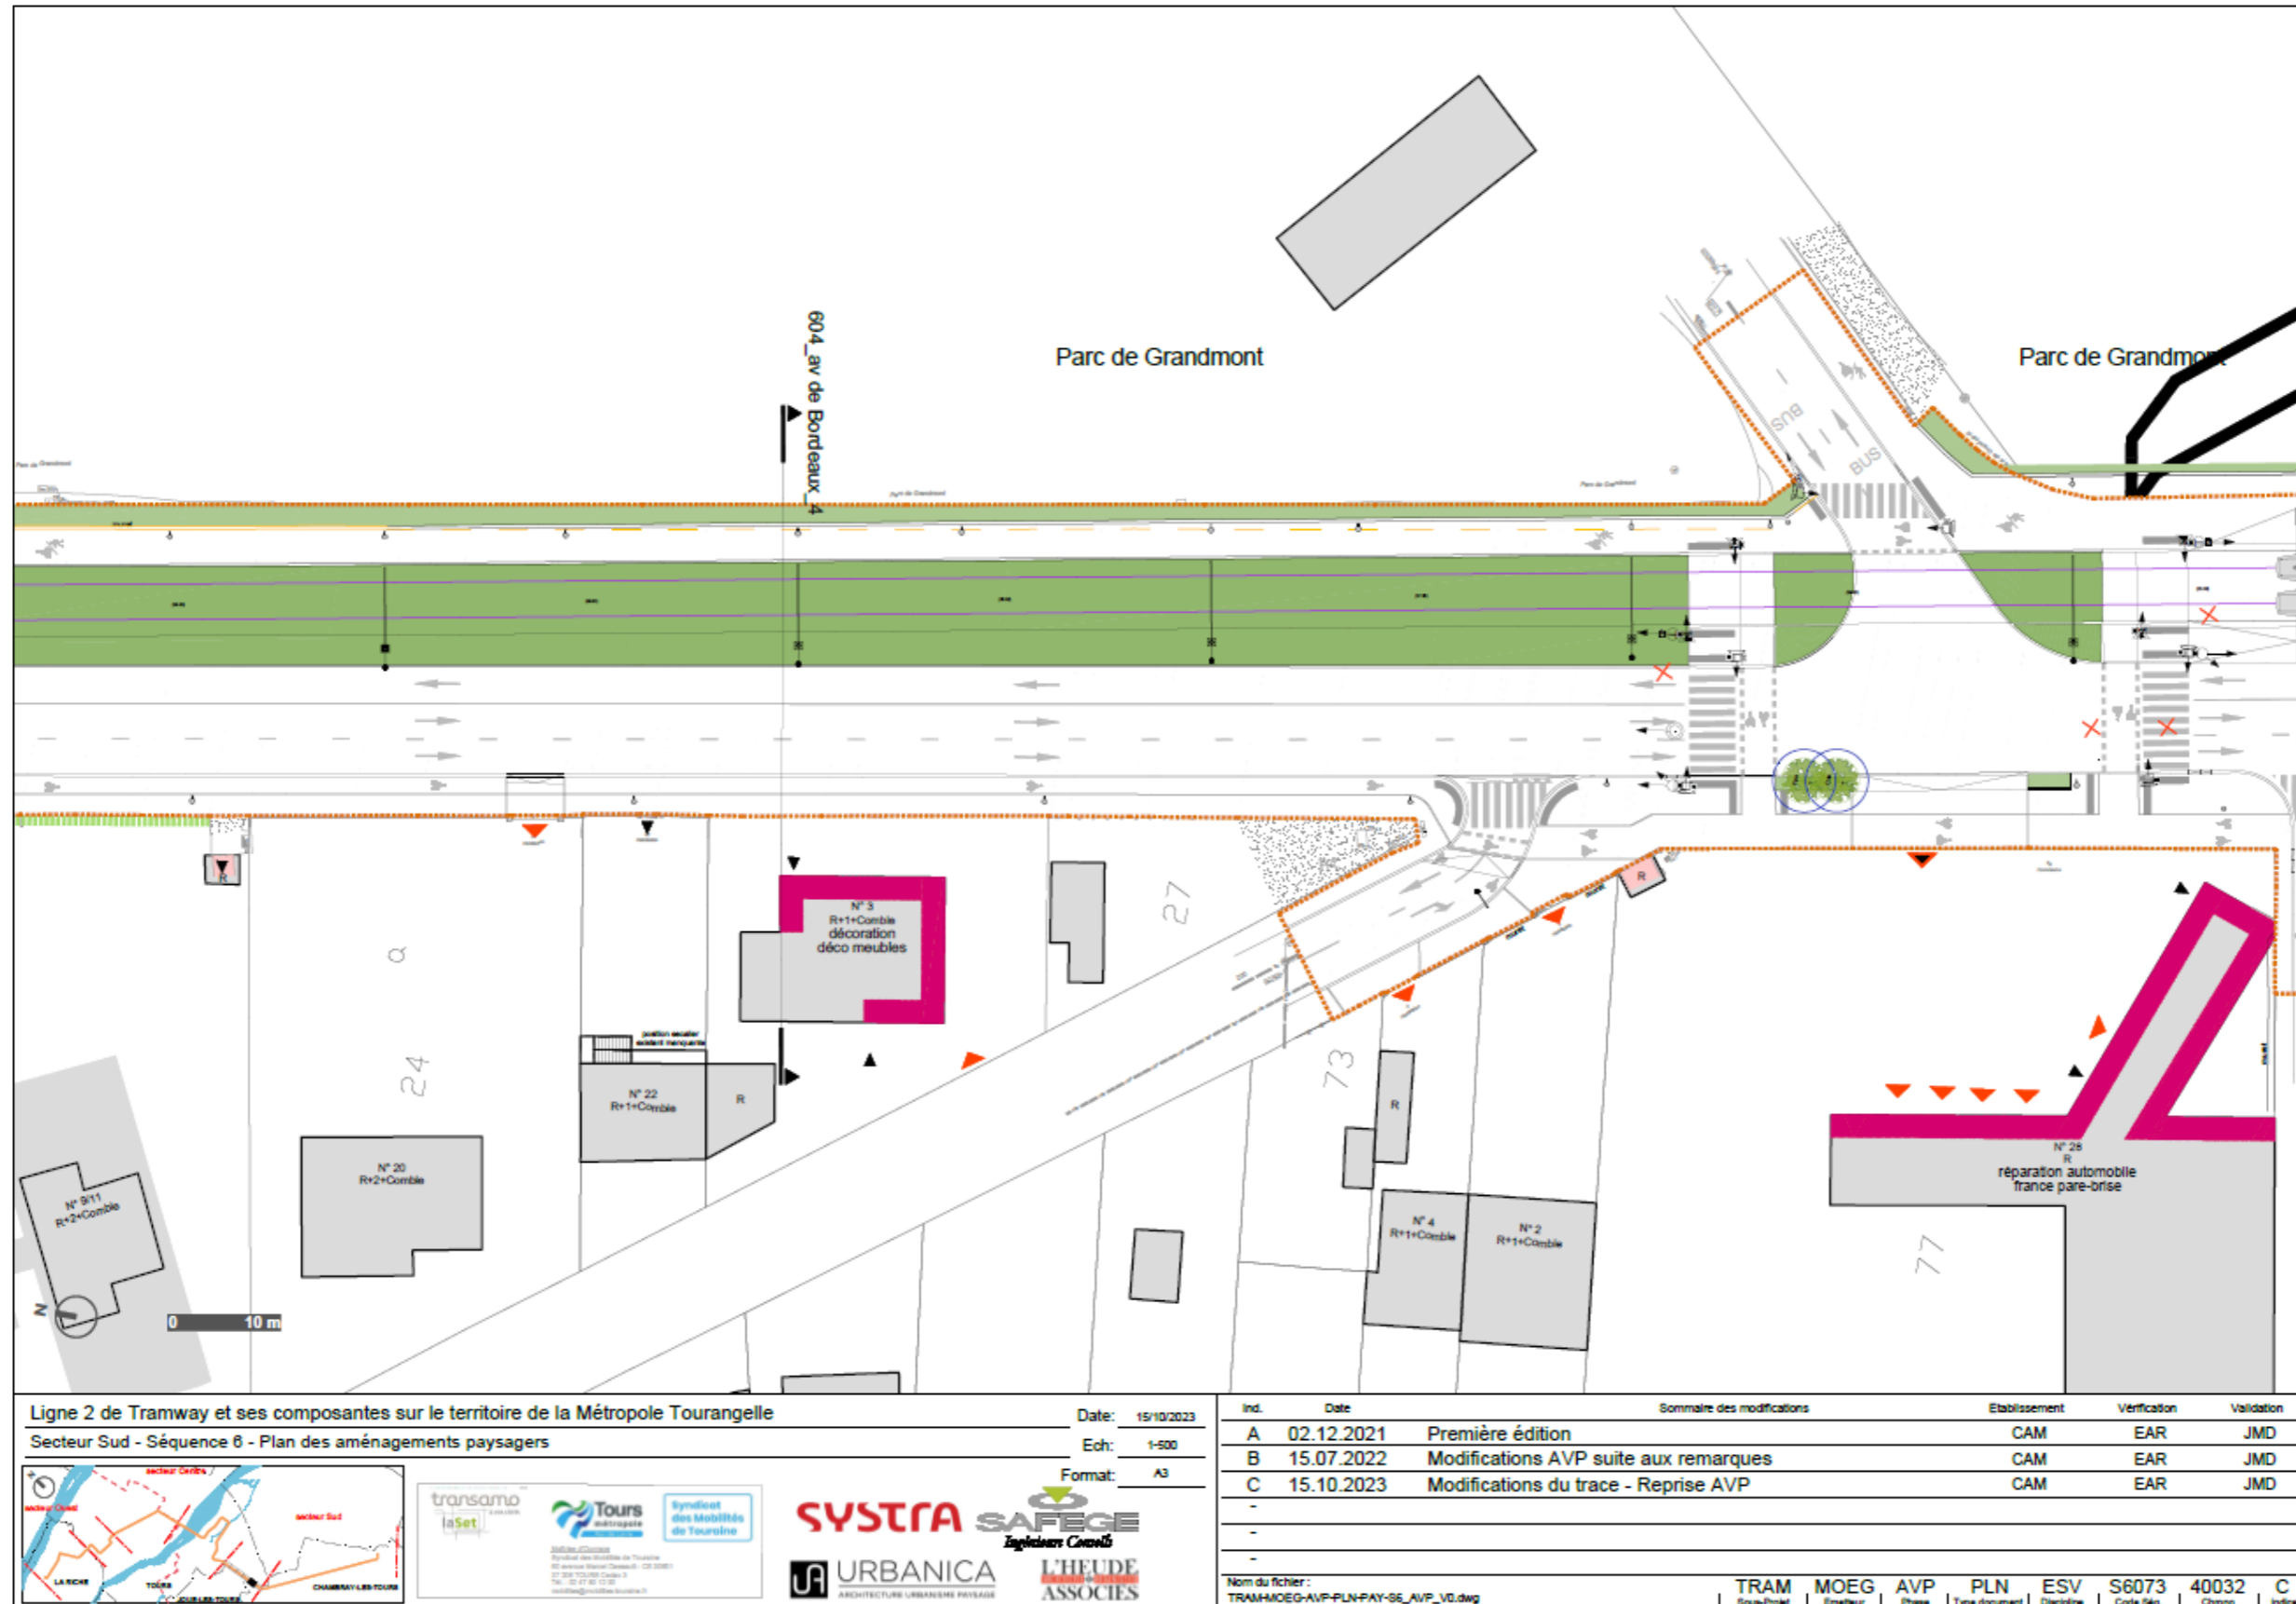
plan masse de localisation des arbres à abattre sur la ligne 2 de tramway - Avenue de Bordeaux (planche 40)
